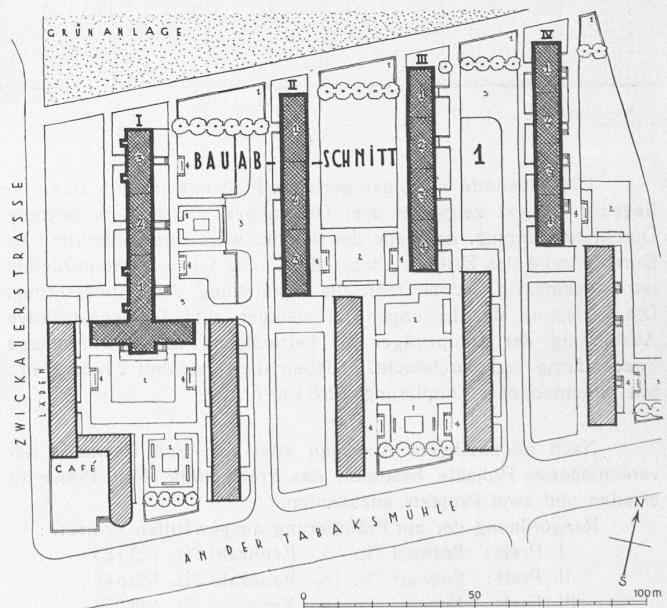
Lageplan der Baumesse-Siedlung Leipzig. — 1 : 2000.
